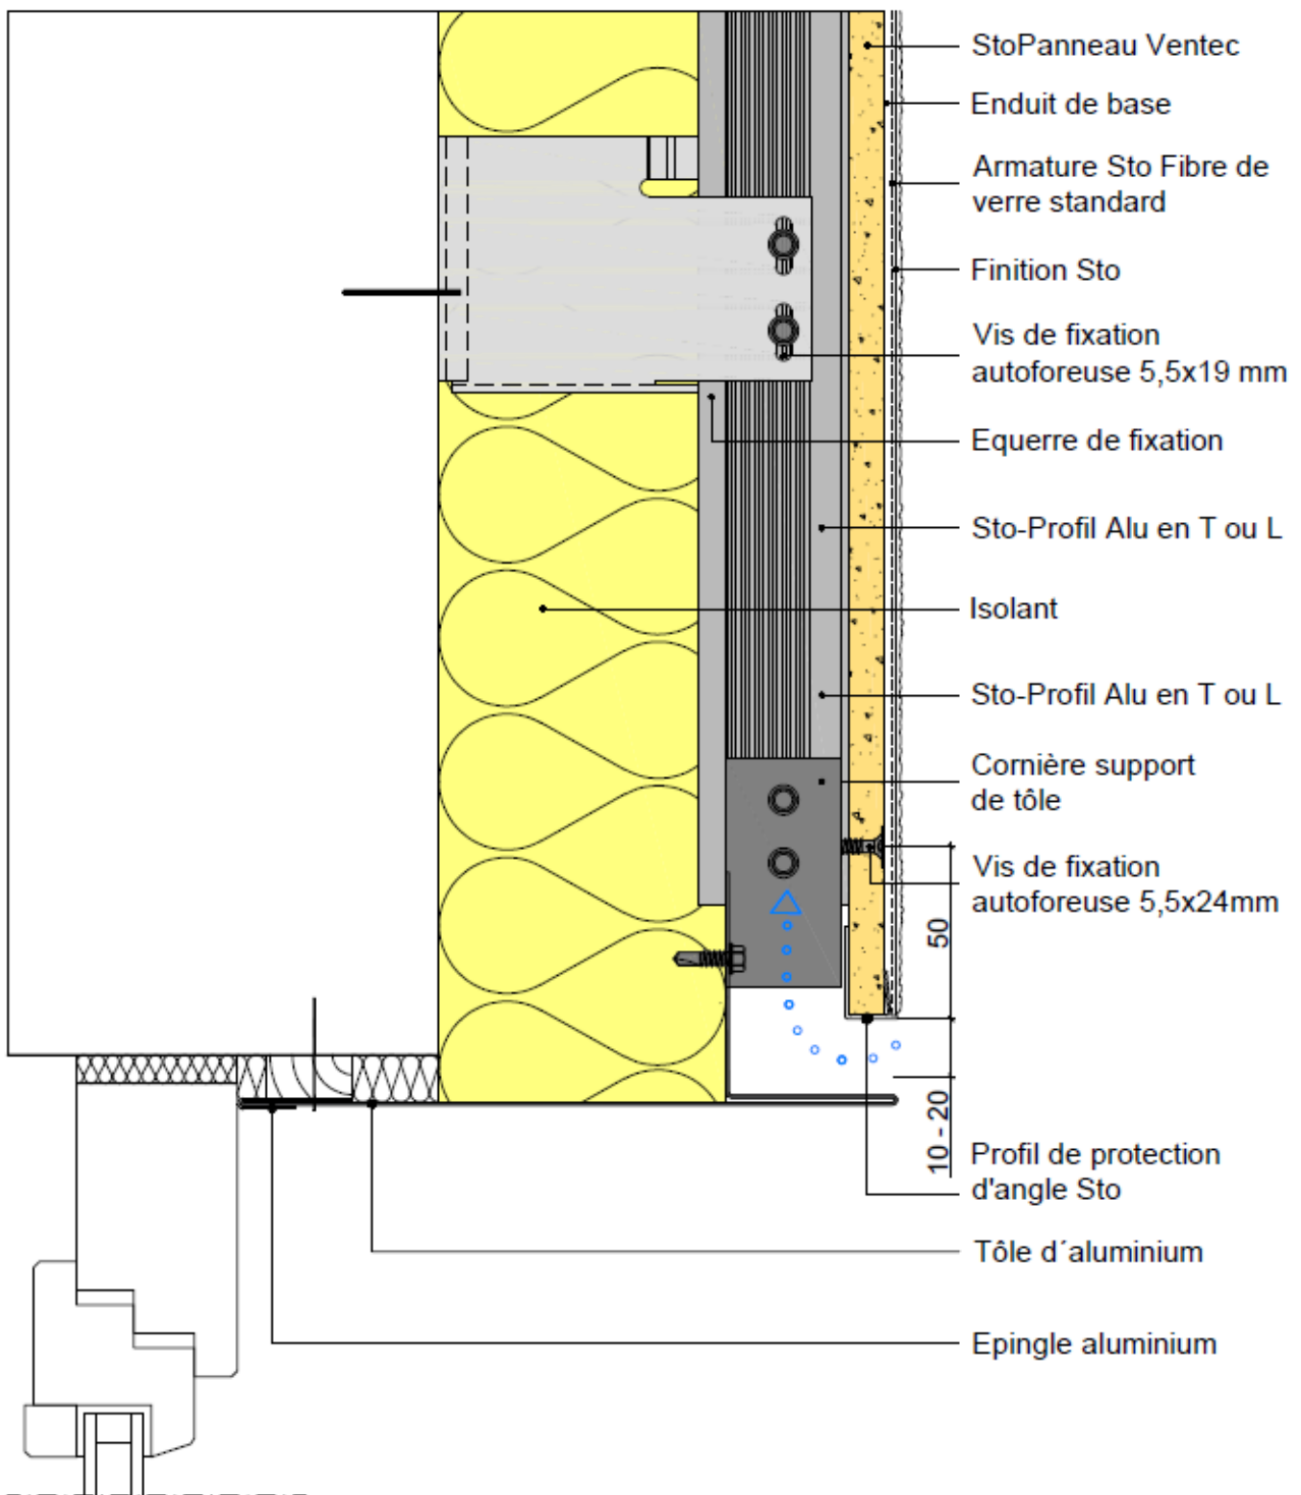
Coupe verticale - Menuiserie posée en tunnel - Traitement de linteau non isolé en retour de parement - Ossatures aluminium sur support béton
